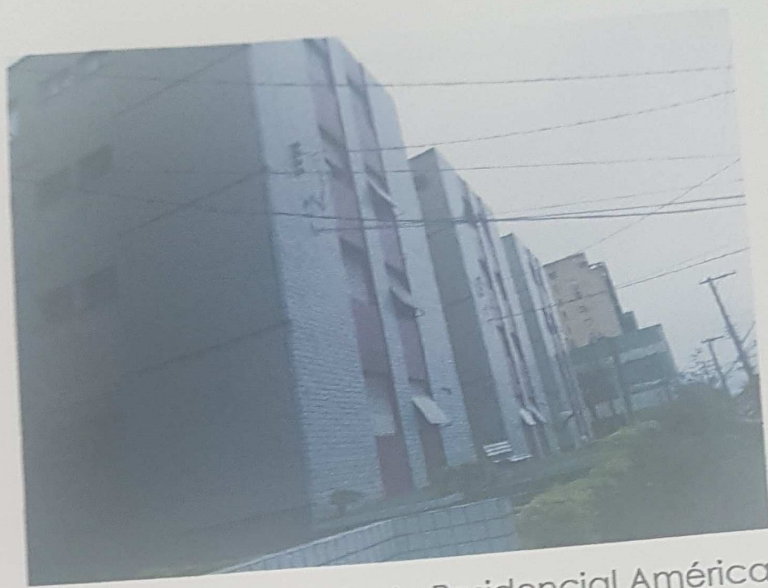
Fachada do Conjunto Residencial América do Sul.
